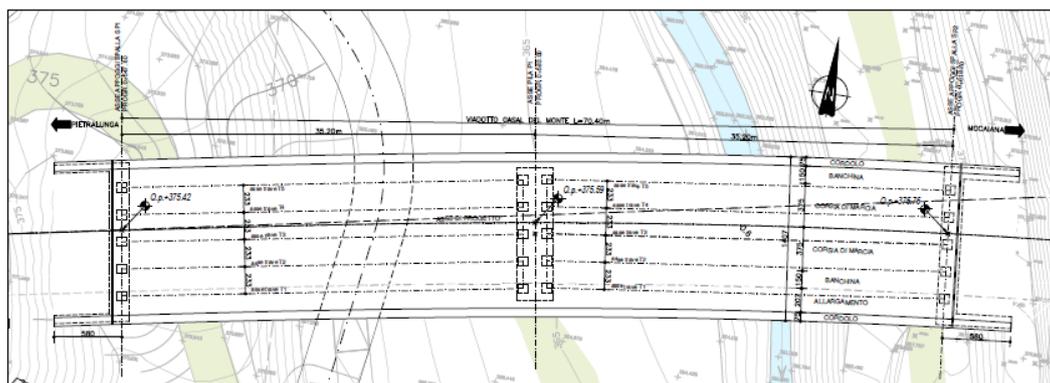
PLANIMETRIA VIADOTTO CASAL DEL MONTE
